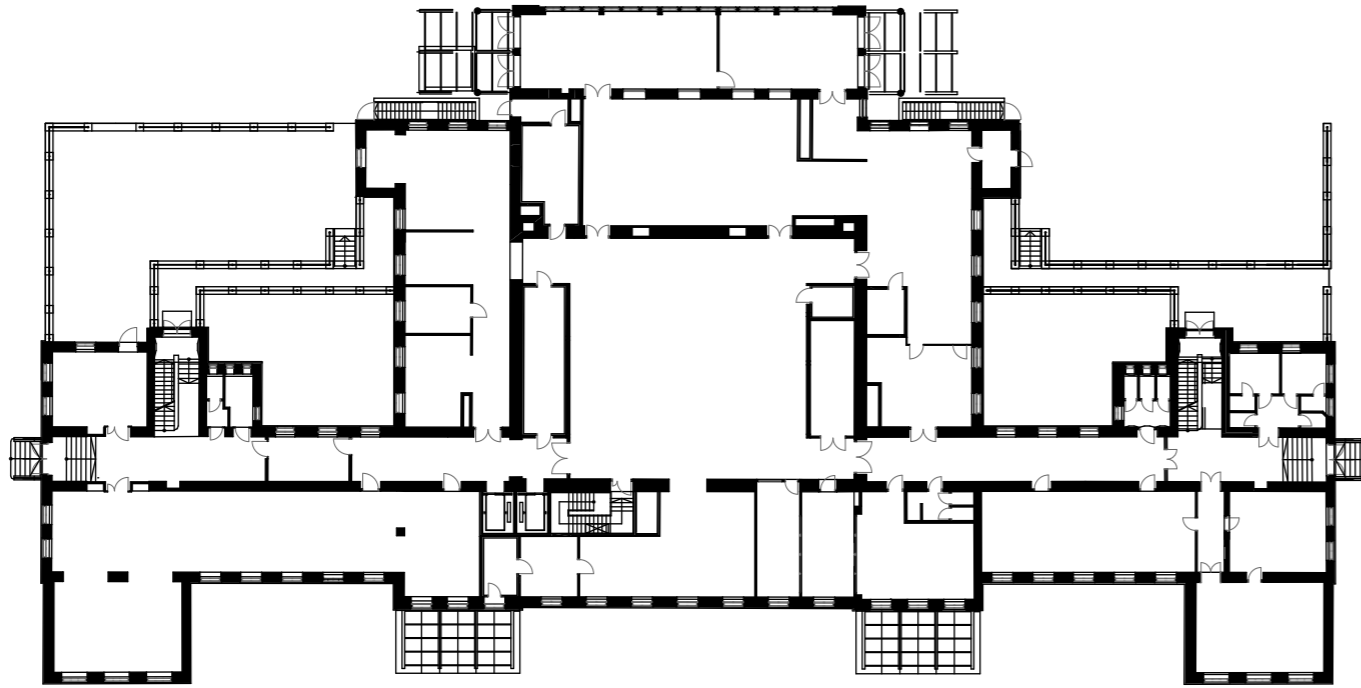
Bestandsplan Küchengebäude | Erdgeschoss | M 1-500
